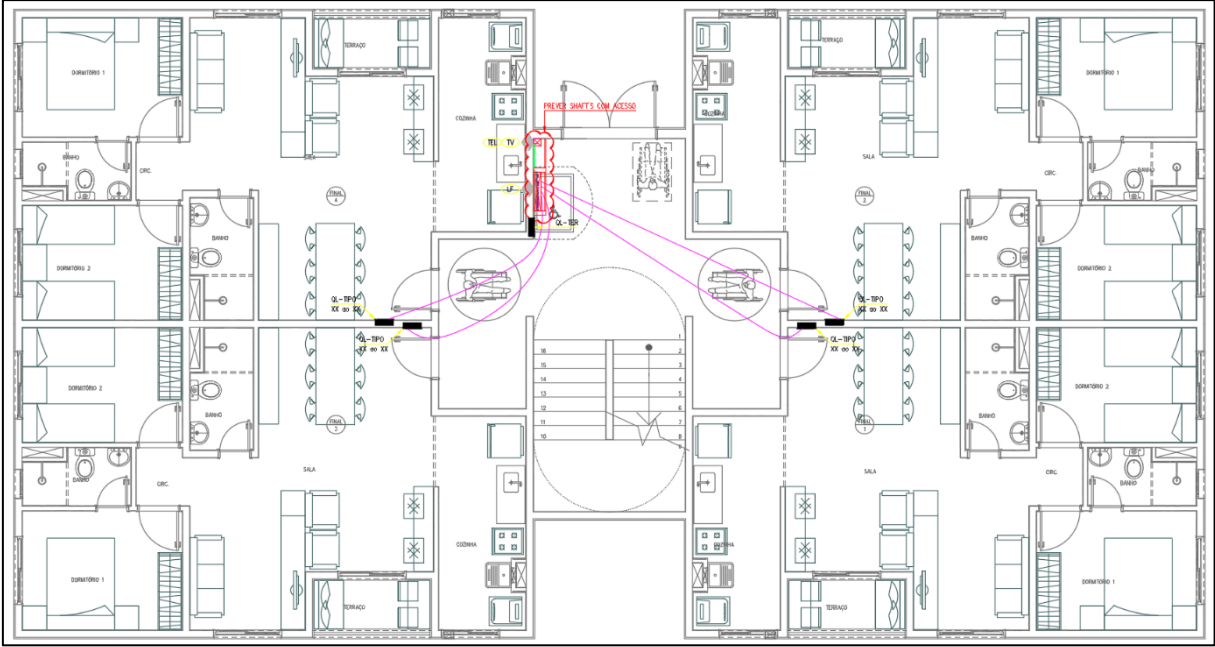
Planta do pavimento tipo em Projeto Executivo
